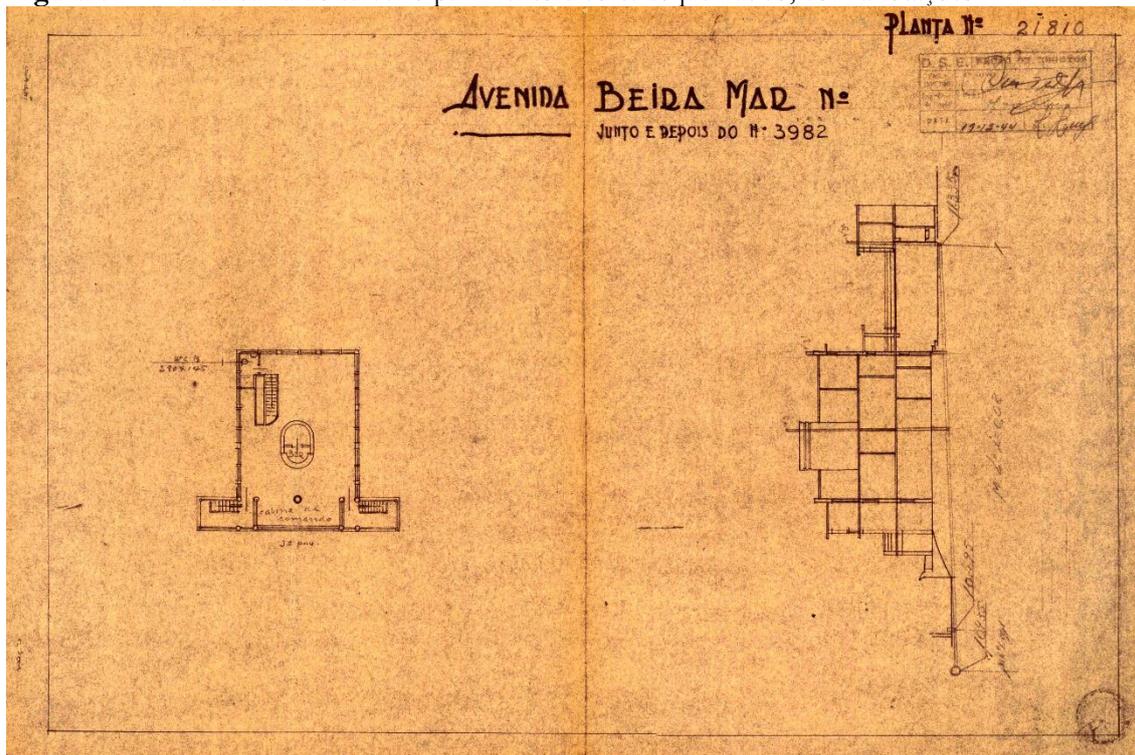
Plantas baixas do primeiro e segundo pavimentos, com anotações.
